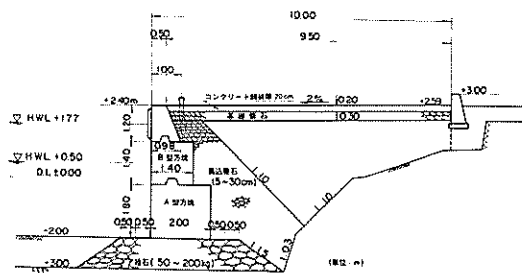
塩釜港要害浦物揚場(-2.0m)東側標準断面図
